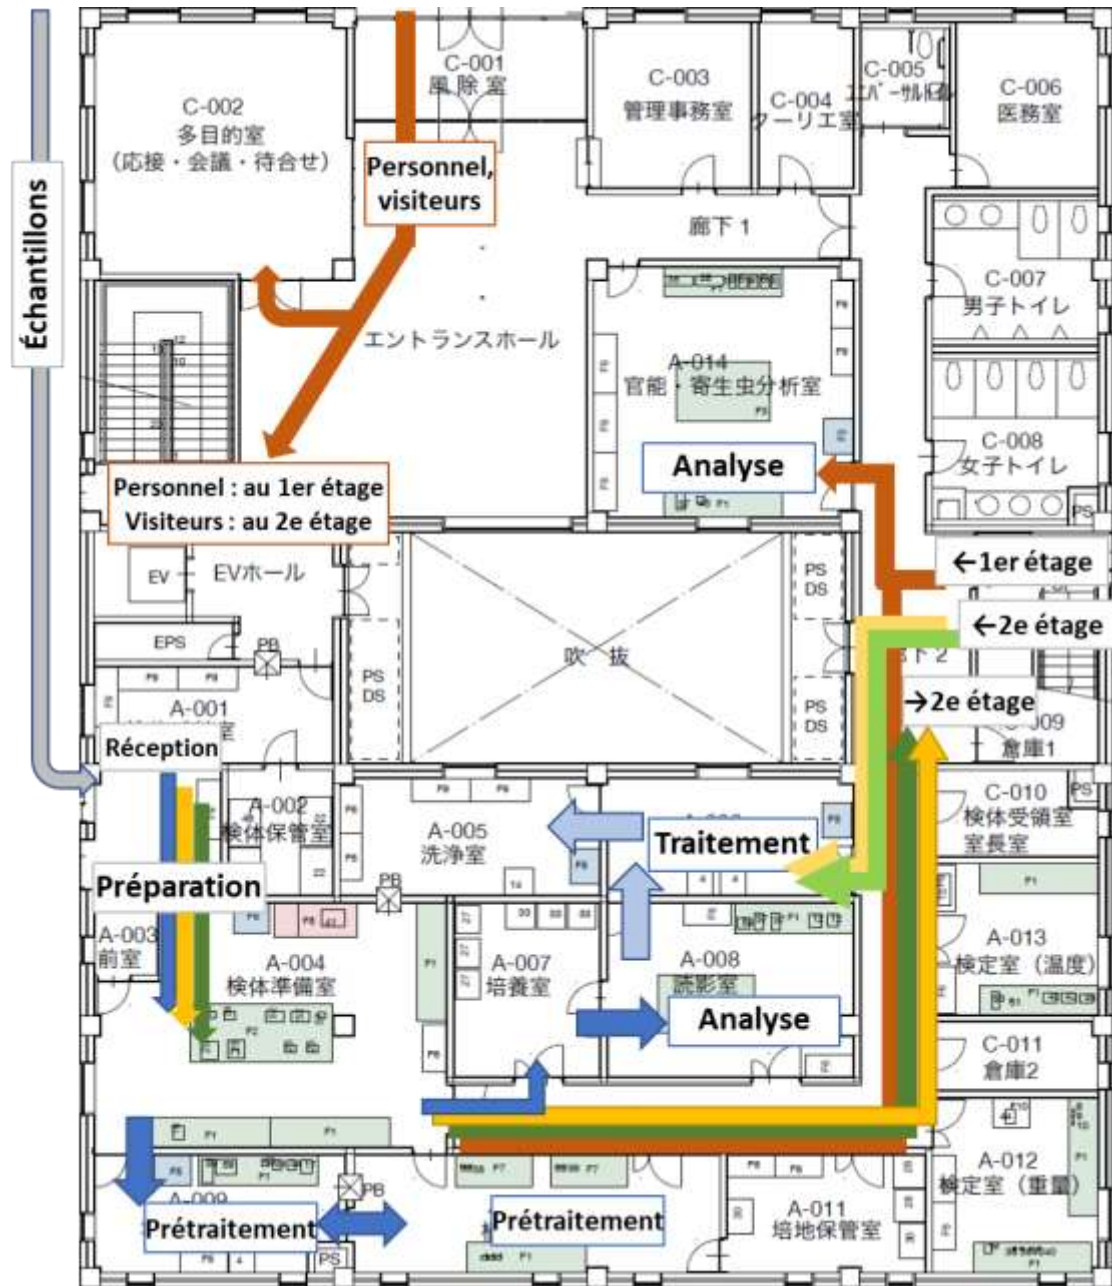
Plan des flux de circulation au rez-de-chaussée
